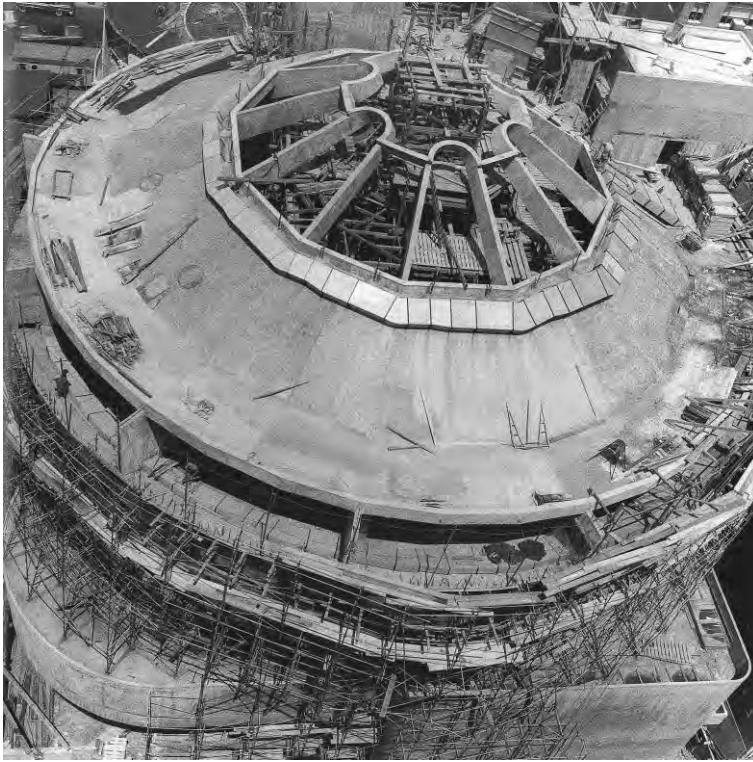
El muro que forma el cilindro de la planta baja y primera nace de los pilares del sótano que delimitan la sala de actos. De este modo, el muro también tiene la función de una gran viga pared entre pilares, permitiendo la entrada de luz a la planta sótano a través de un patio inglés lateral. La intersección entre los pilares y el cilindro puede considerarse como una región “D” puesto que el gradiente de tensiones es muy alto alrededor del apoyo.
